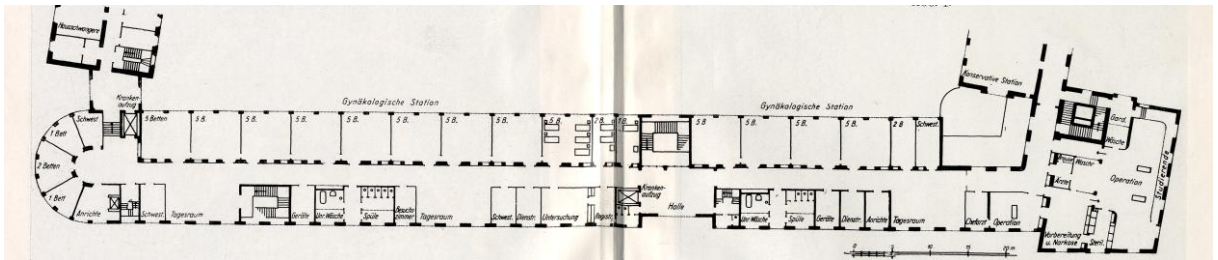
Grundriss zweites Obergeschoss Z-Bau (Stoeckel 1932 S. 672 f)
